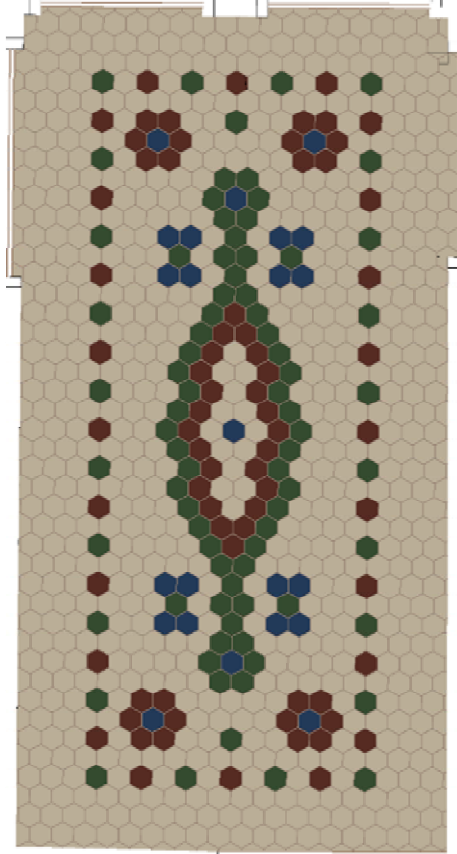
Levantamiento gráfico pavimento. Fuente propia.
